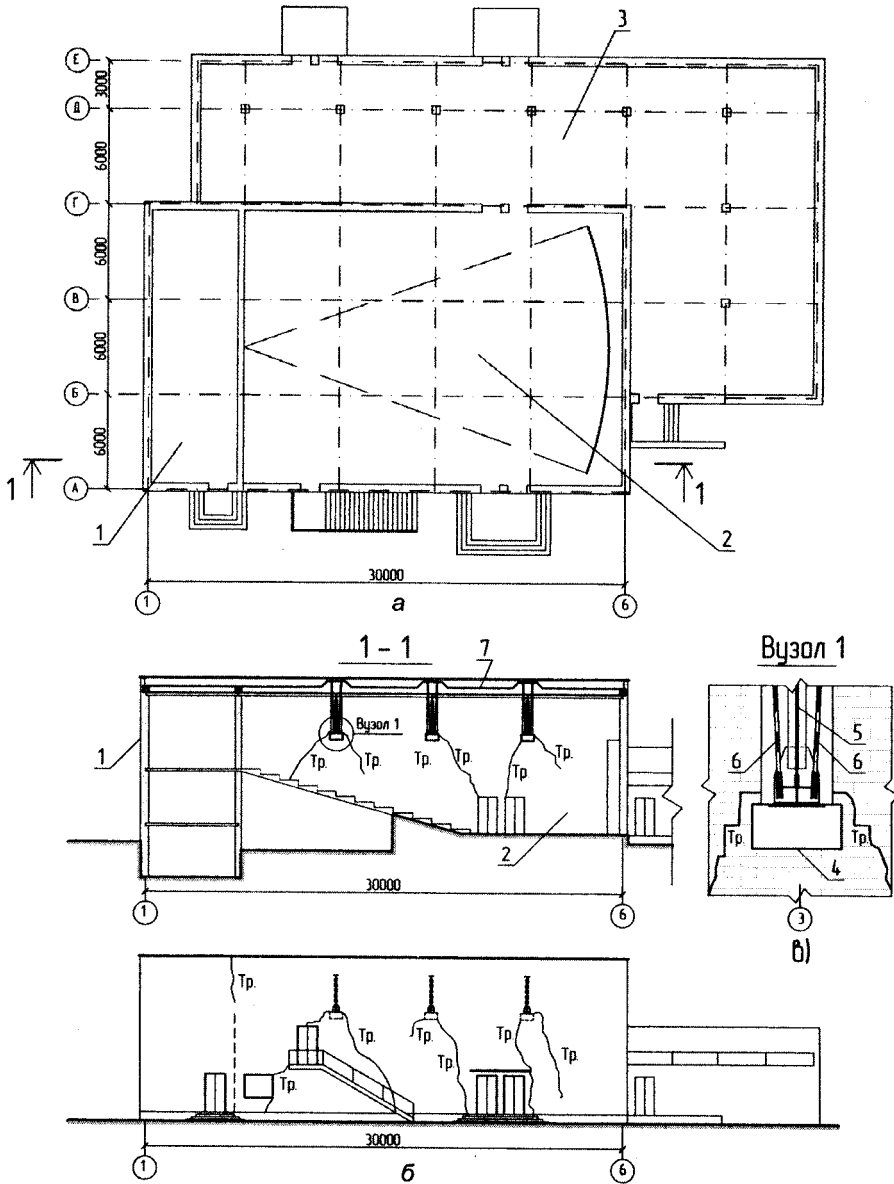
План будинку кінотеатру (а); фасад в осях 1–7 (б); вузол опирання кроквяної ферми на несучу стіну (в): 1 – багатопверхова частина будинку; 2 – зал для глядачів; 3 – одноповерхова частина, фойє, кафе; 4 – монолітні опорні подушки МОП-1; 5 – металеві ферми прольотом 18 м; 6 – тяжі-підвіски; 7 – монолітний залізобетонний пояс; Тр – видимі тріщини 0,5...3,0 мм у цегляних стінах
